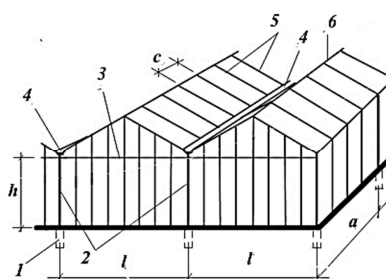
Конструктивная схема блочной теплицы: 1- фундамент; 2 – стойки из прокатного двутавра; 3 – затяжка; 4 – лоток из гнутого швеллера для удаления осадков; 5 – шпросы из сдвоенных уголков для опирания стекла; 6 – коньковый прогон
